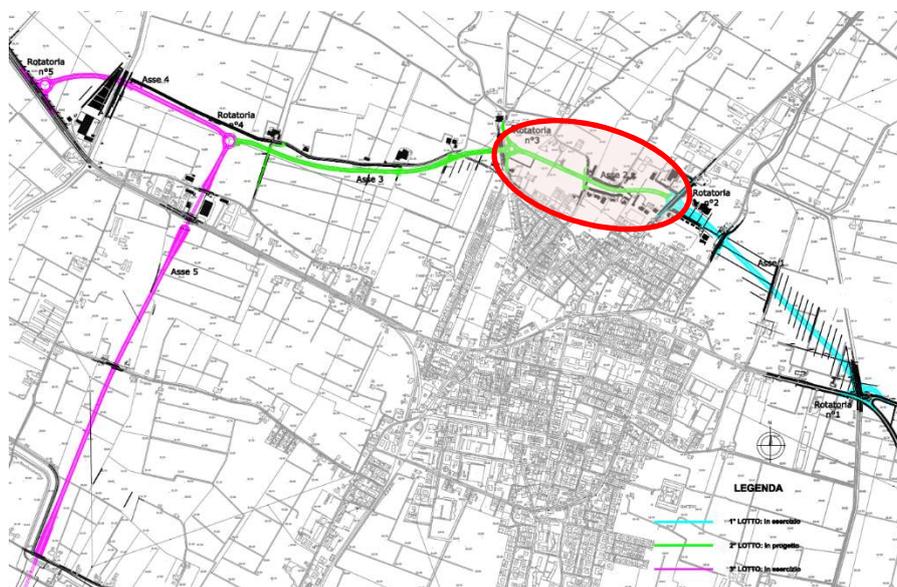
Planimetria generale dell'itero intervento con evidenziato ultimo lotto
